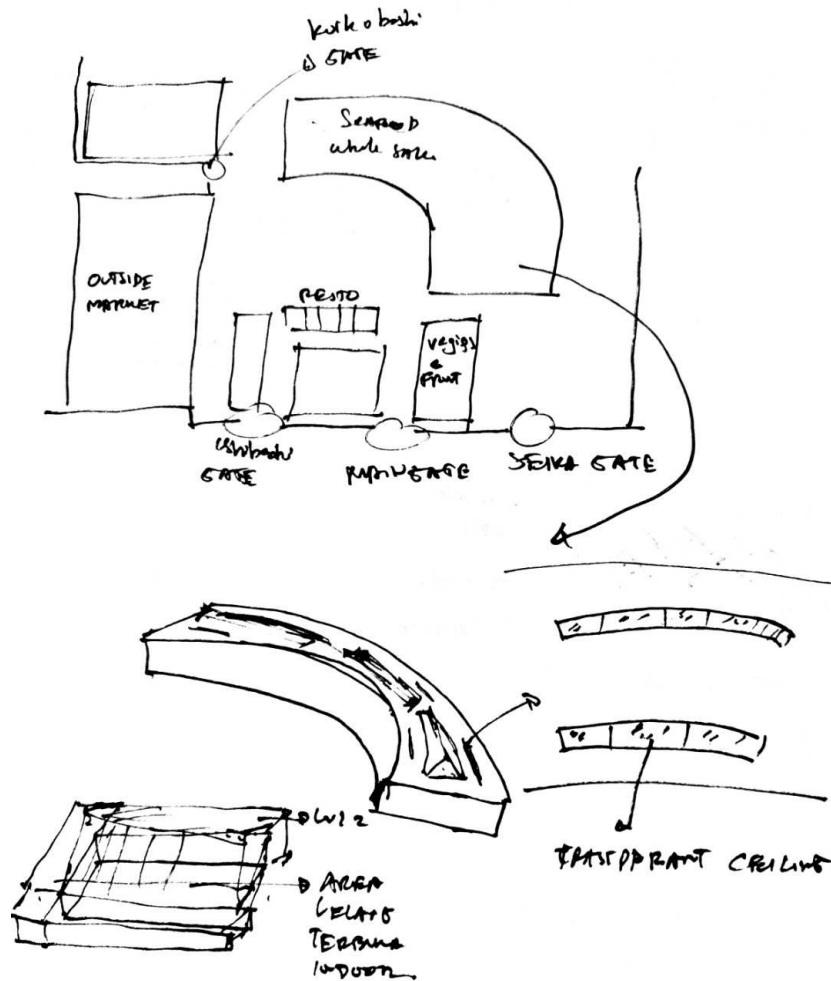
Foto Pasar Tsukiji.)
